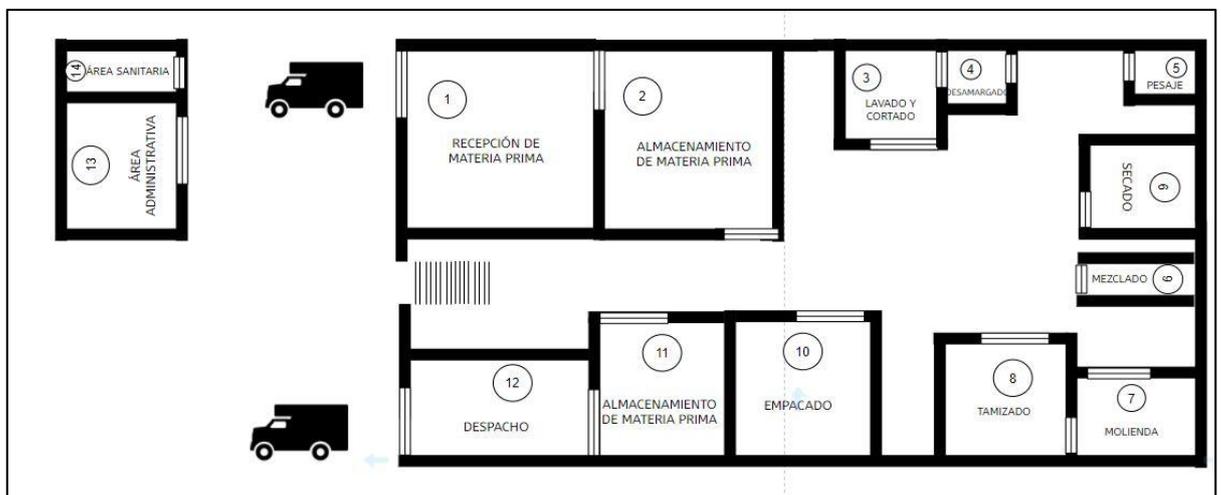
Esquema de distribución de planta en U [Elaboración propia]
